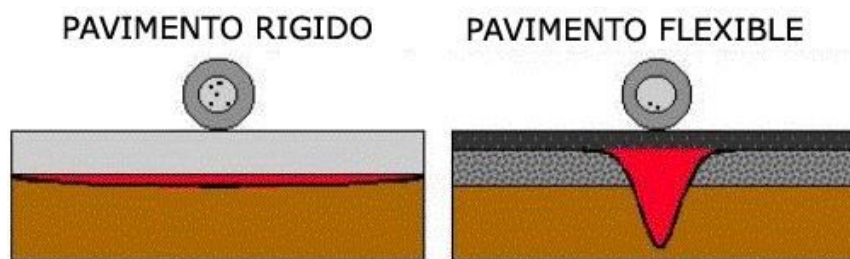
Comportamiento del pavimento Flexible y Rígido
